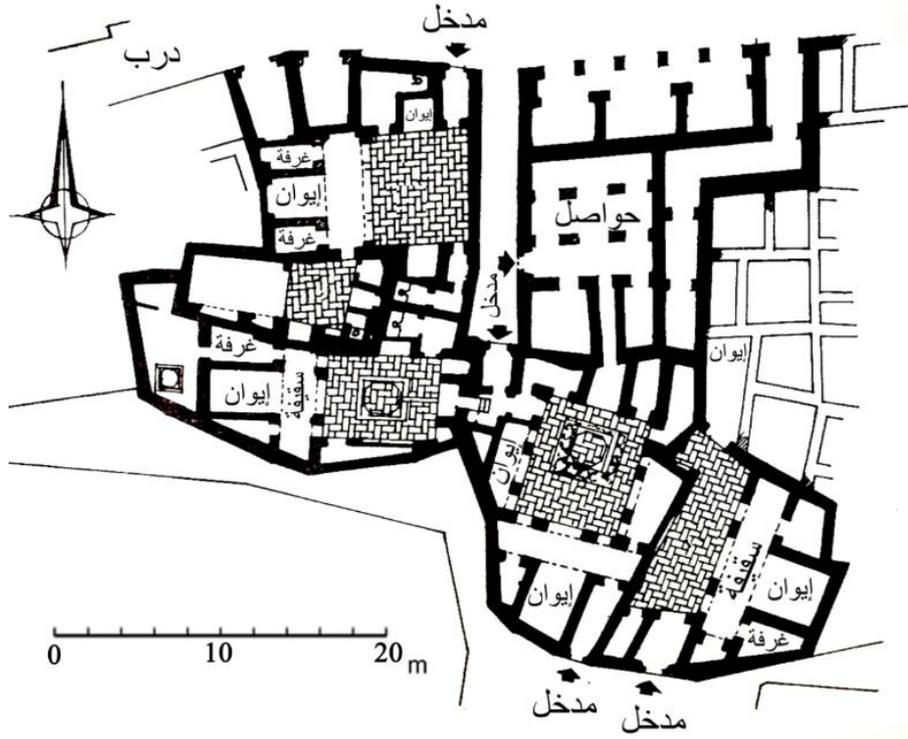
مسقط أفقي للبيت الطولوني الأول<sup>3</sup>.
